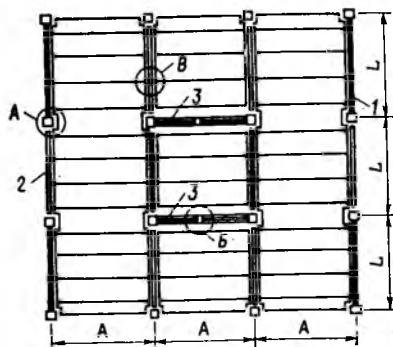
Конструктивные системы многоэтажных каркасных зданий (фрагмент плана)
